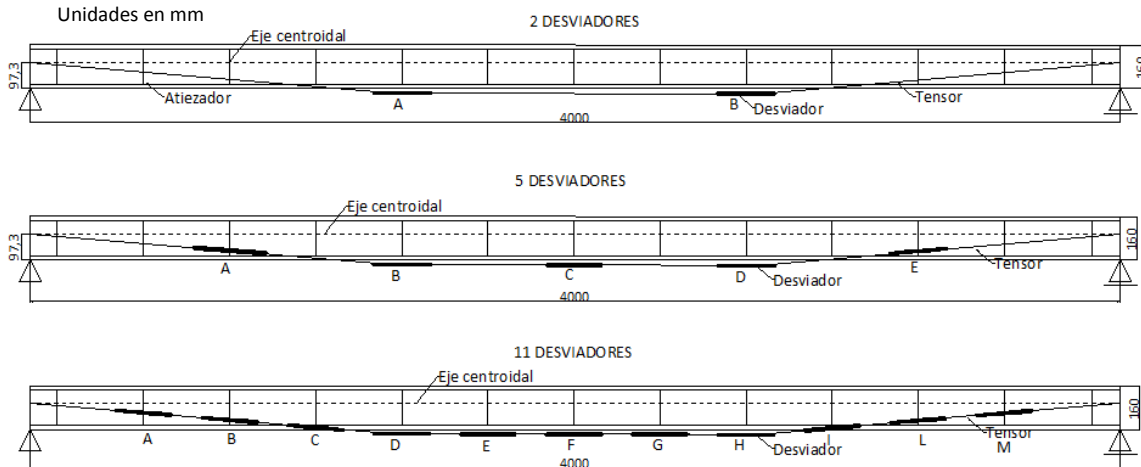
Configuración de las vigas tipo I analizadas con 2, 5 y 11 desviadores.
